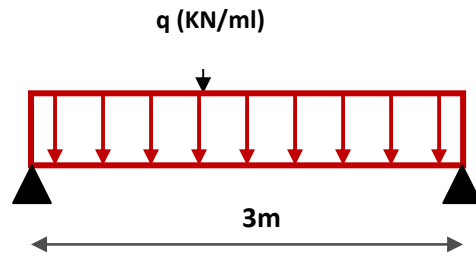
Schéma statique de la poutre palière (RDC)
